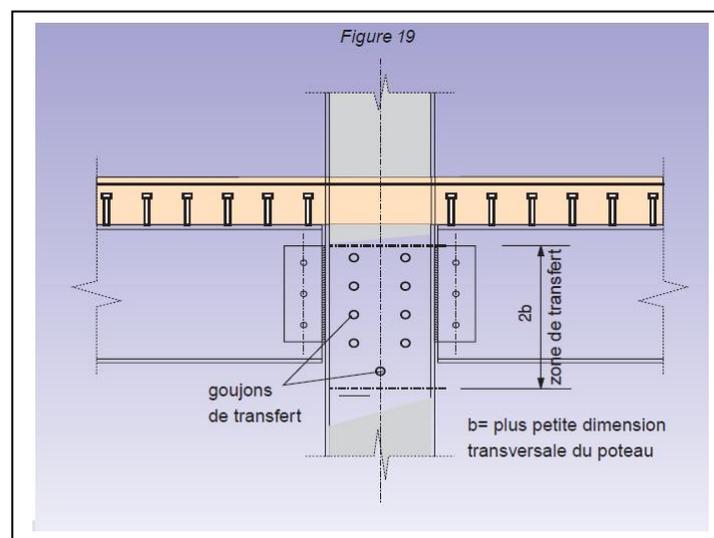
assemblage poteau, poutre alvéolaire avec un plancher collaborant
